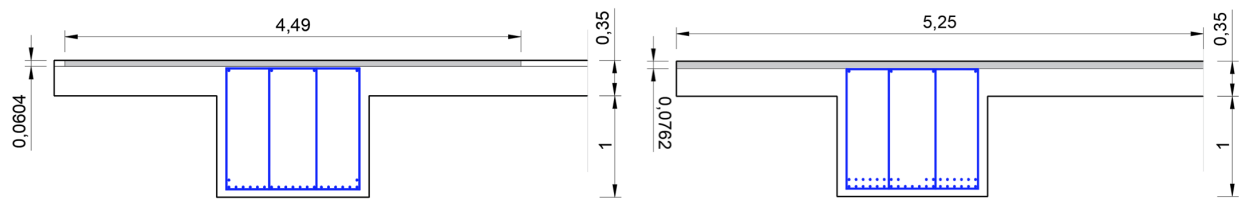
Placering av tvärkraftsarmering, tvärled. Författarens egen figur.
